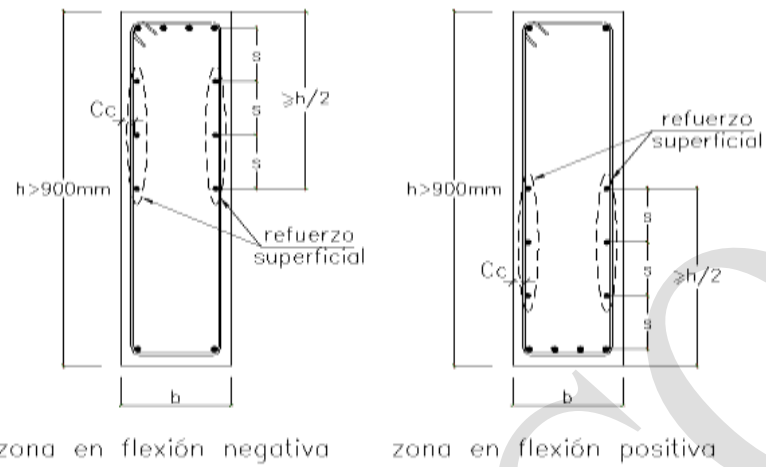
Refuerzo superficial en vigas con peralte mayor a 900 mm
